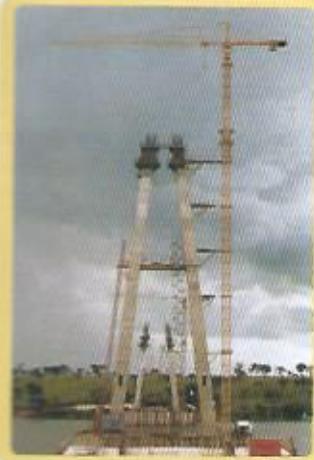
Ponte sobre o Rio Paranaíba [Construtora Queiroz Galvão]
